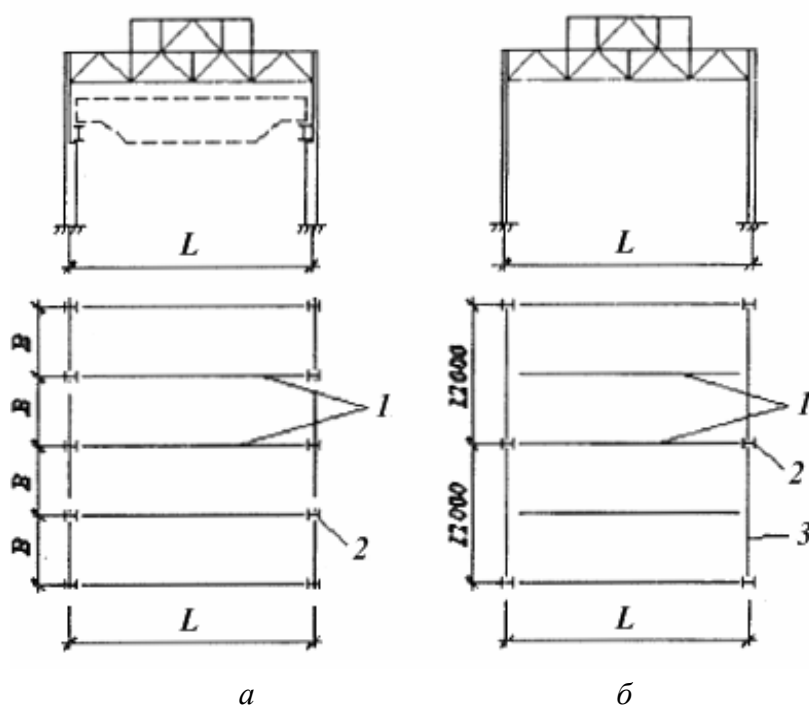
Конструктивні схеми каркасу однопролітних виробничих будівель: а – крок колон і ферм однаковий; б – крок колон більший за крок ферм; 1 – кроквяні ферми, 2 – колони, 3 – підкряквяні ферми
